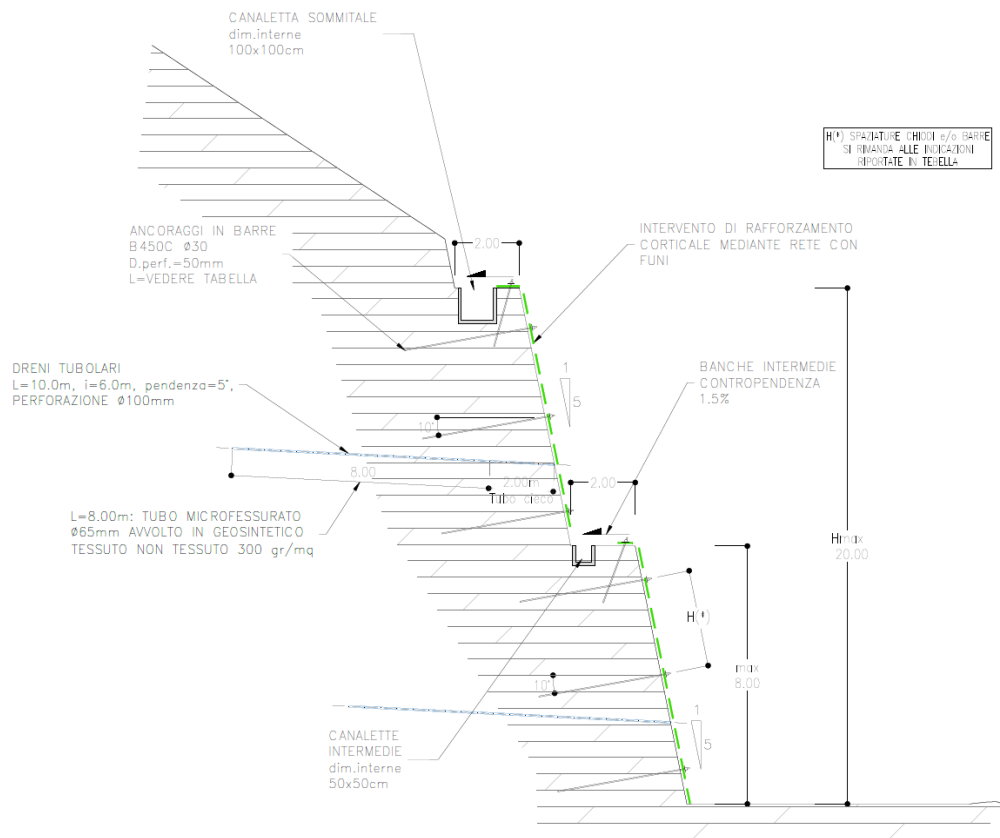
Sezione tipo scavo in marna fucoide TS-B
